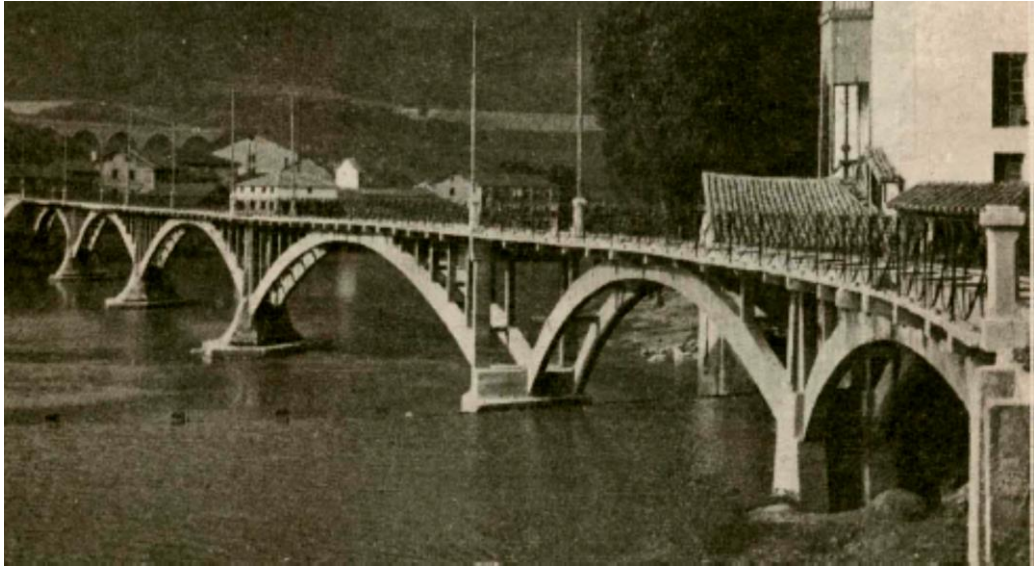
Puente de La Peña, Vizcaya, Gabriel Rebollo. Tomo I Puentes de fábrica y hormigón armado. 1925. Biblioteca digital Fundación Juanelo Turriano
